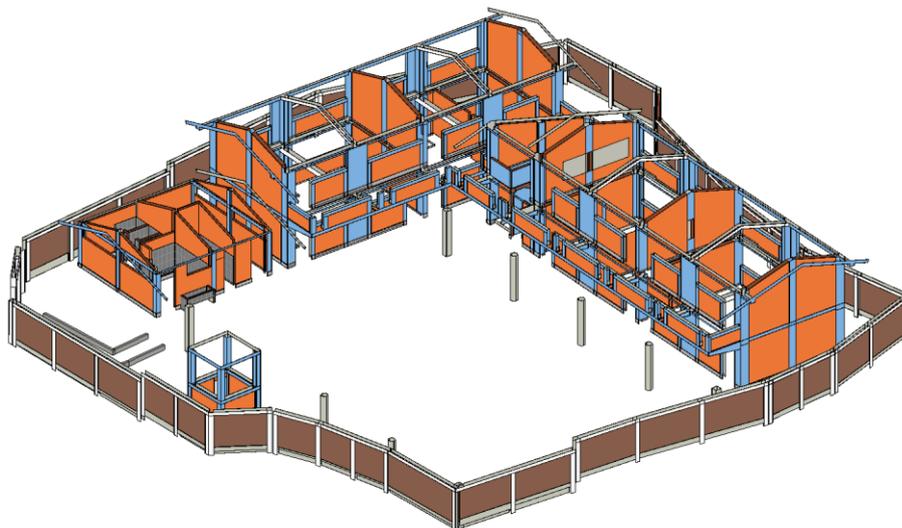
Categoría Muros aislado del modelo federado de Arquitectura
